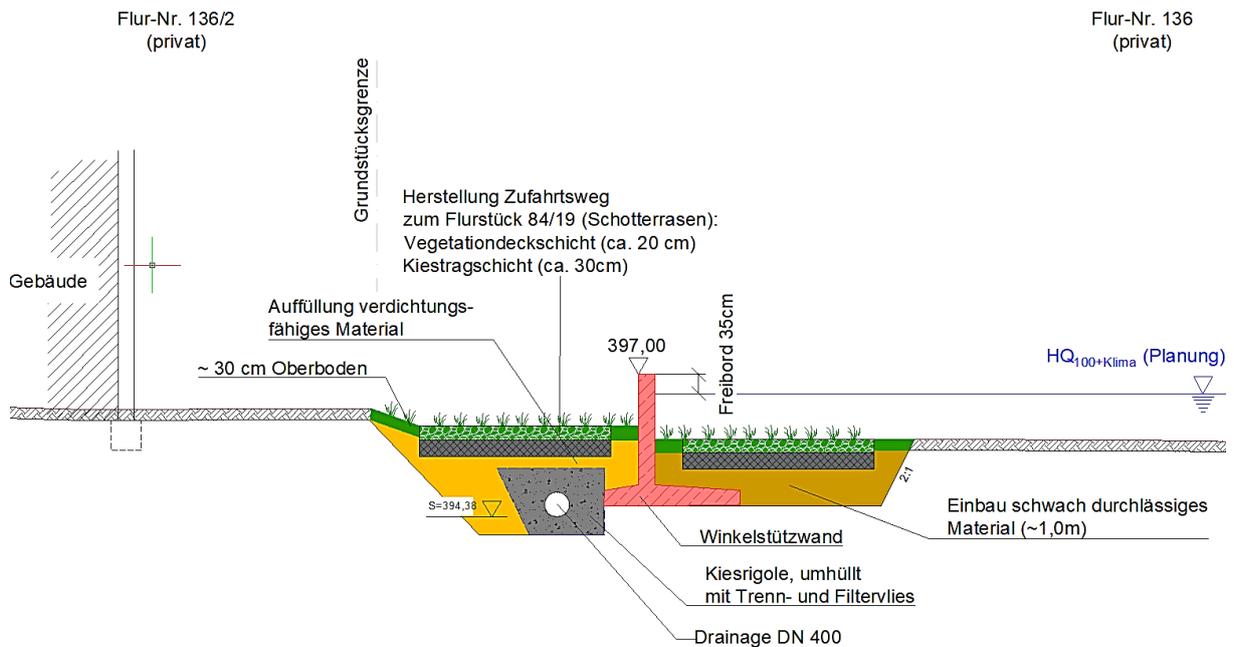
Schutzwand im Abschnitt 3 (Ausschnitt aus Querschnittsplan E40)
